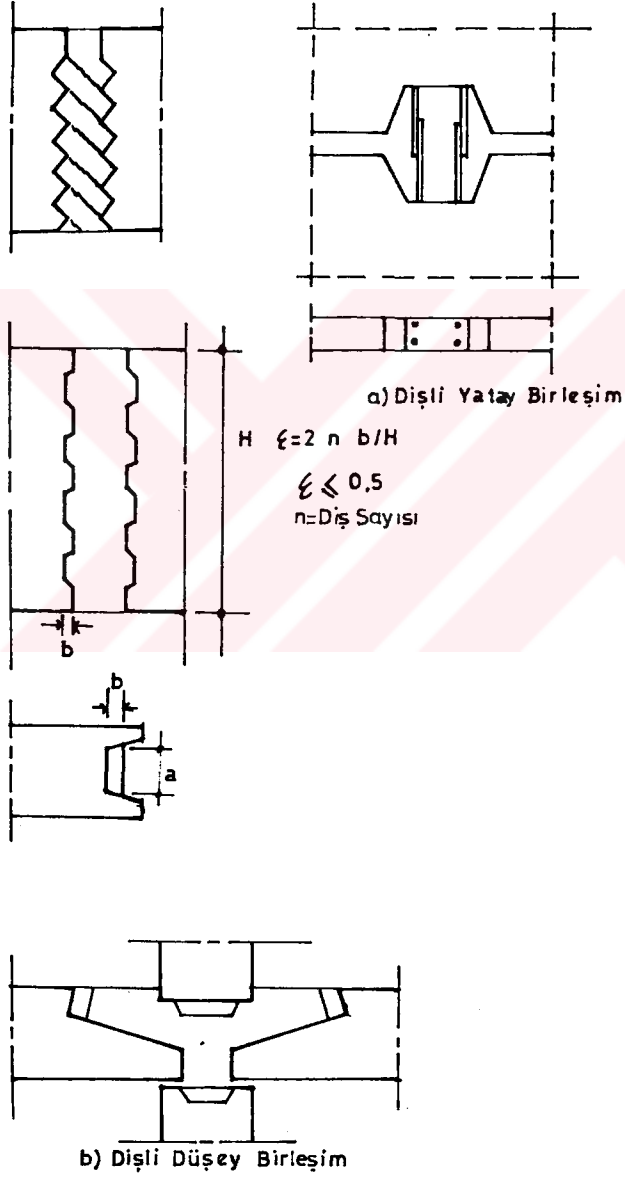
Prefabrike Panel Yapıların davranışı
